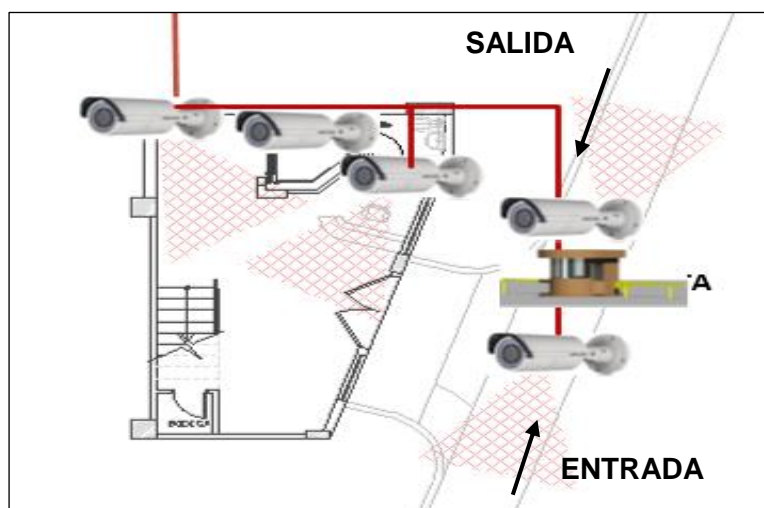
Ubicación de equipos para video vigilancia en planta baja y garita
